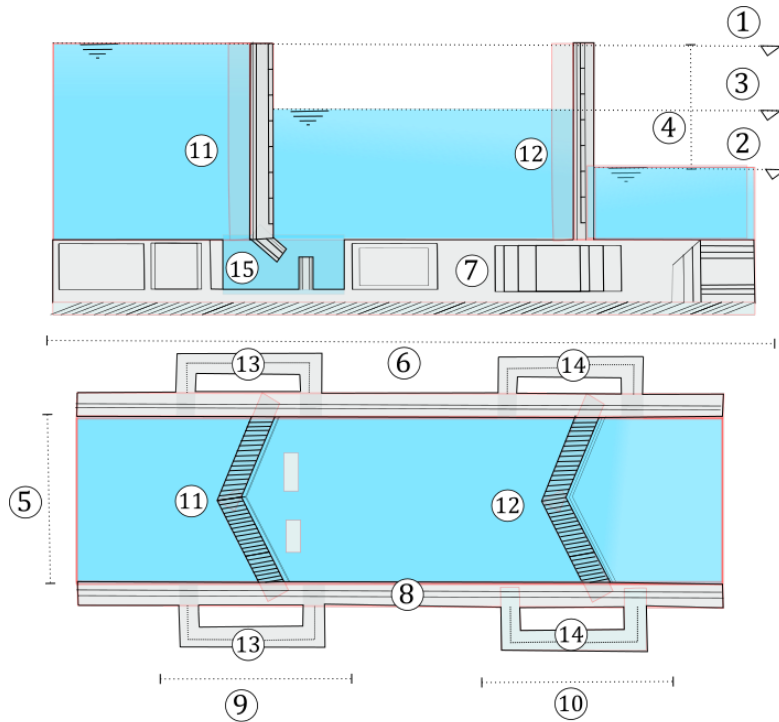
Vue en plan et longitudinale d'une écluse
